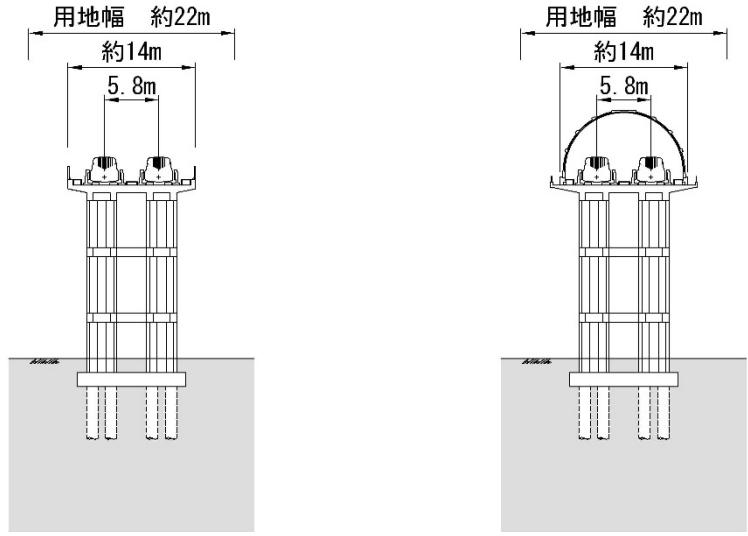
標準的な高架橋（新形式高架橋）の断面図
